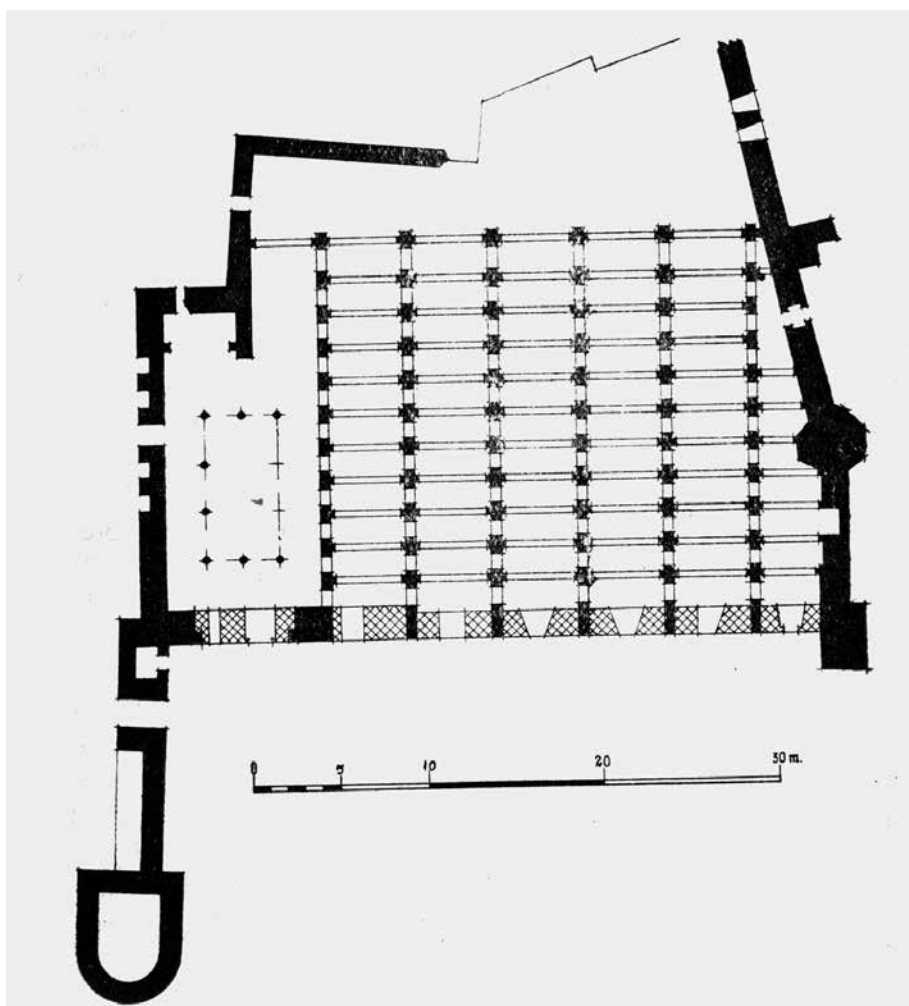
Planta de las Atarazanas de Málaga, 1773.
